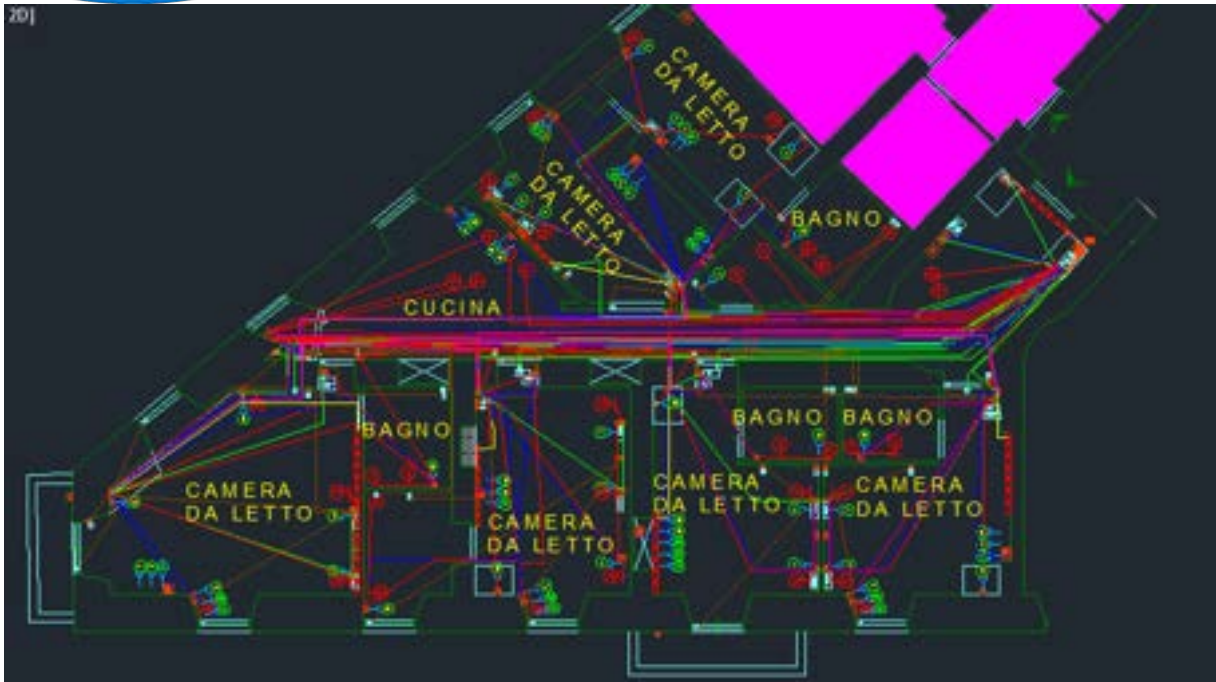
Pianta del bed and breakfast con schemi d'impianto
